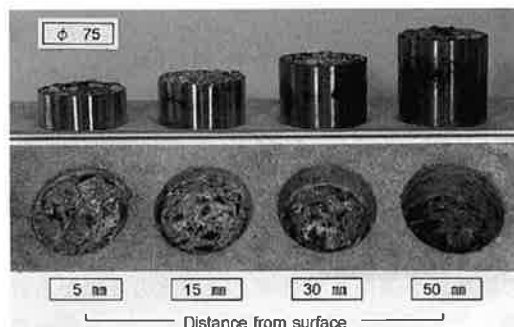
改良プルオフ法によるコンクリート表面の引張破断状況
